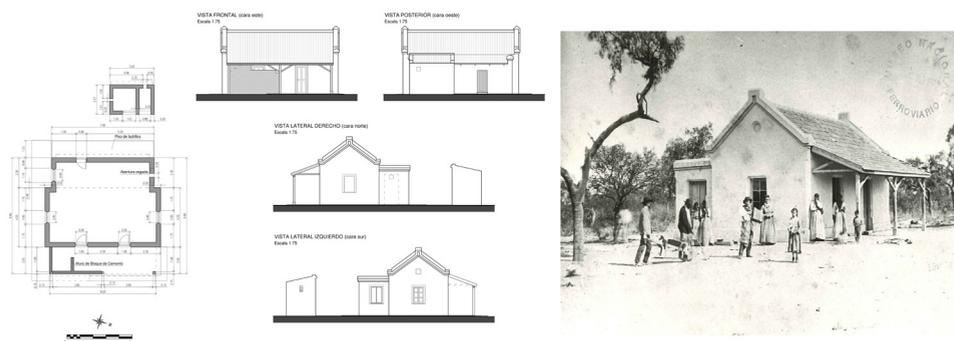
Planimetría actual de la antigua vivienda del capataz. Fuente: Museo Nacional Ferroviario.
